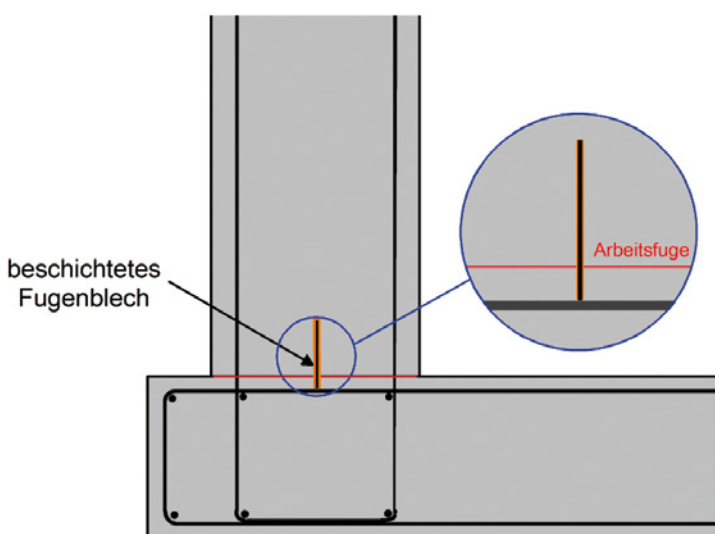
Abdichtung der Arbeitsfuge mit einem beschichteten Fugenblech
